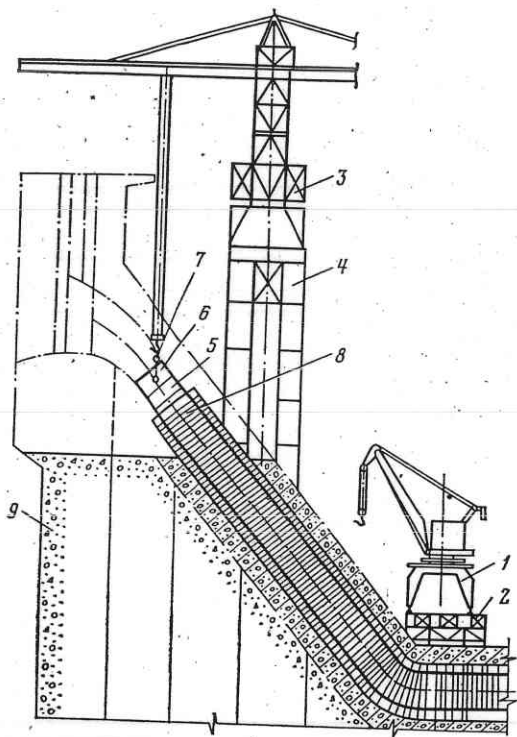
Монтаж напорного трубопровода консольно-навесным способом:
